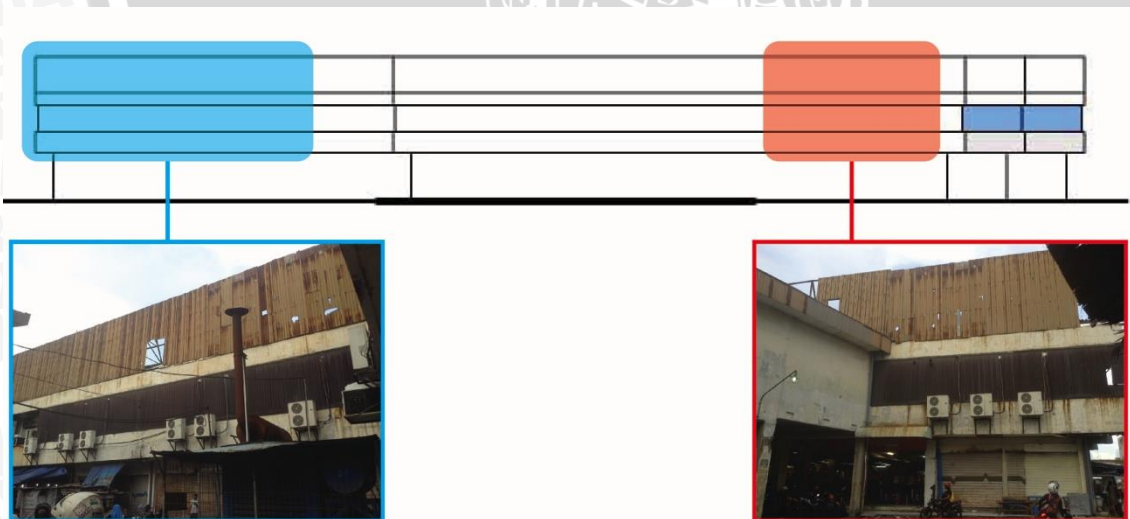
Tampak depan (timur) bangunan eksisting
